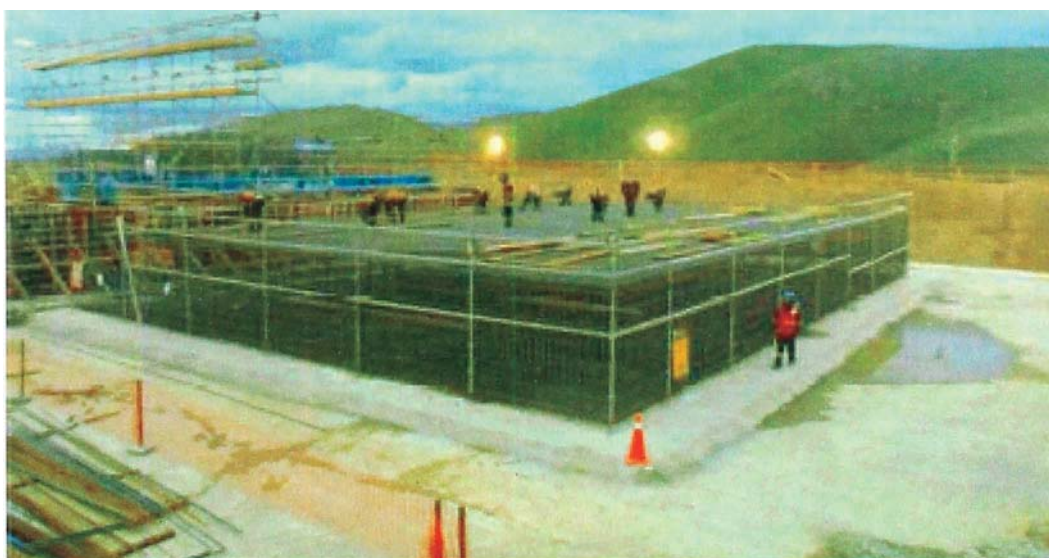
Distribución de trabajadores para colocar las barras de refuerzo.
